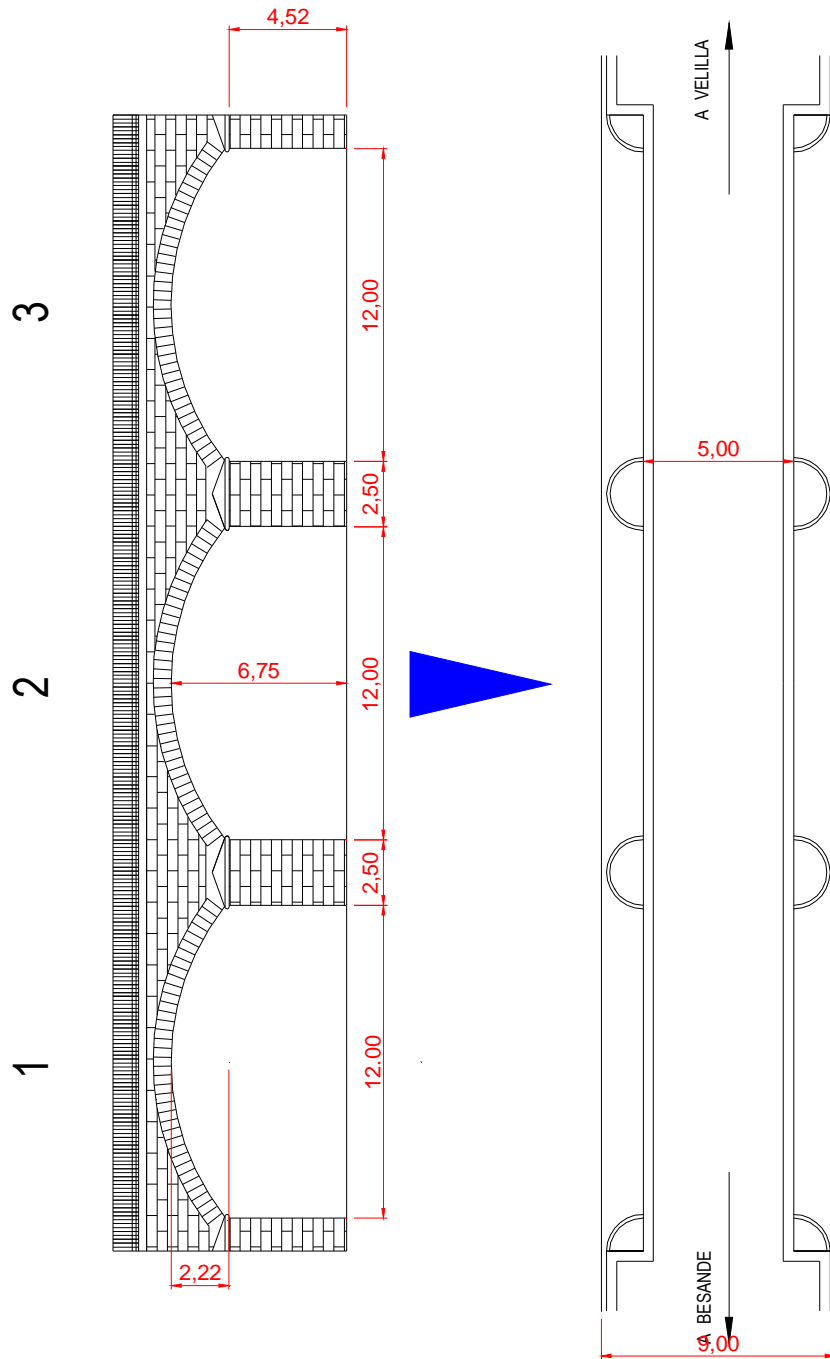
Dibujo de planta y alzado del puente de Velilla del río Carrión.
